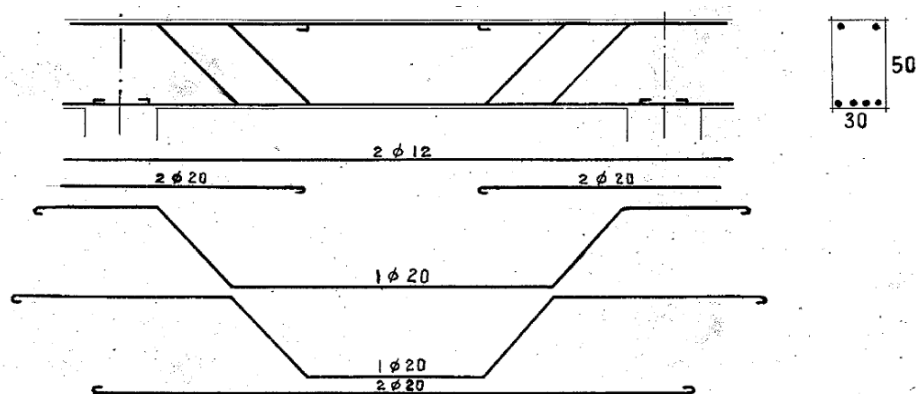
Detalle del doblado de la armadura longitudinal cerca del apoyo. Edificio ficha 103C.004, 1958.
